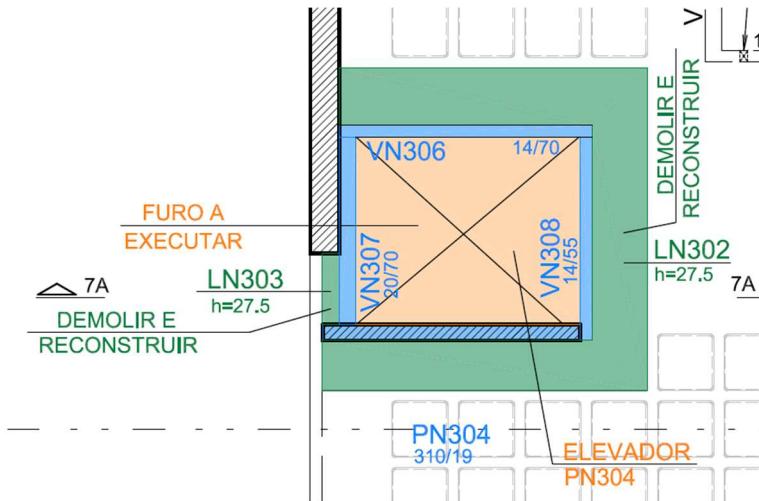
Detalhe em planta da execução do novo furo para o poço de elevador no 3ºSS e da parte da laje a ser demolida e reconstruída.
